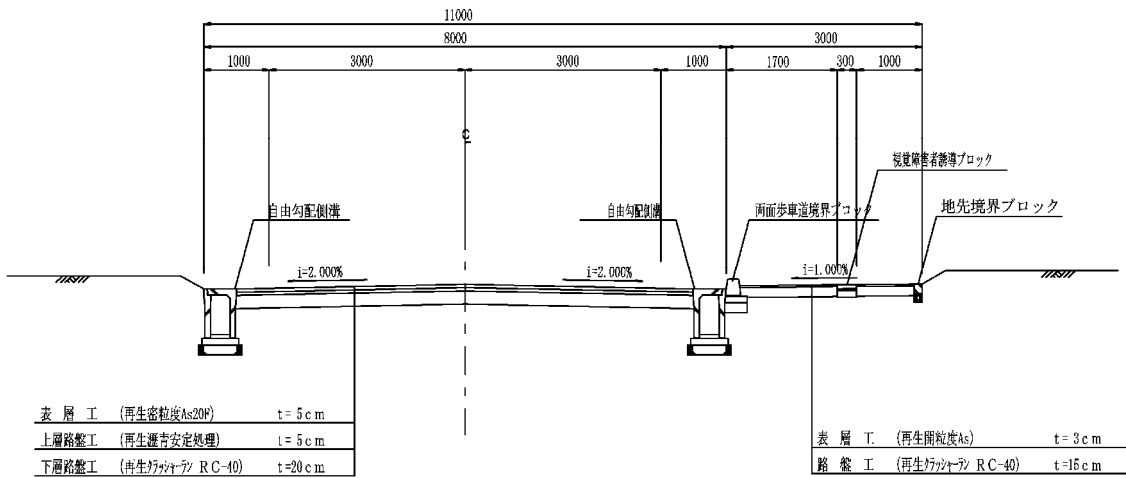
(4) 道路標準断面図(補助幹線道路:11m)
